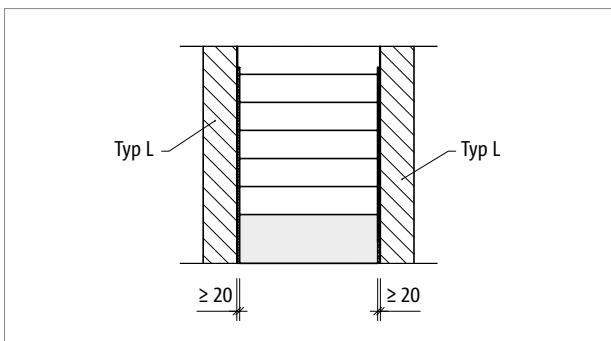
Schöck Tronsole® Typ L: Berücksichtigung von Einbautoleranzen
